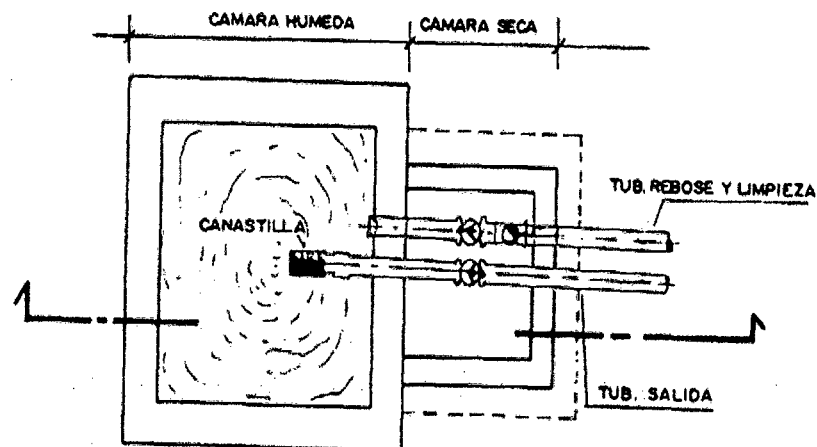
PLANTA Y PERFIL DE CAPTACION DE FONDO
